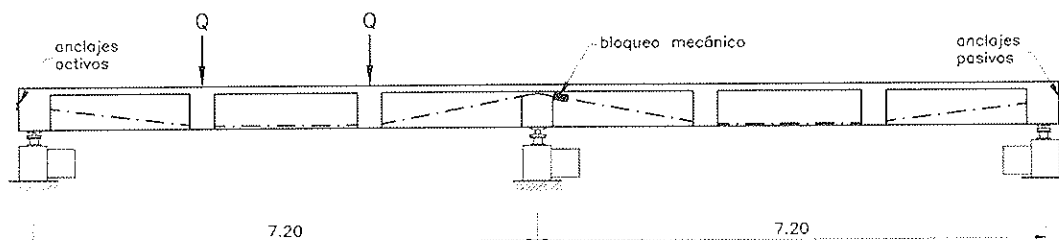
Trazado de pretensado de la viga en el ensayo VCBLO.
